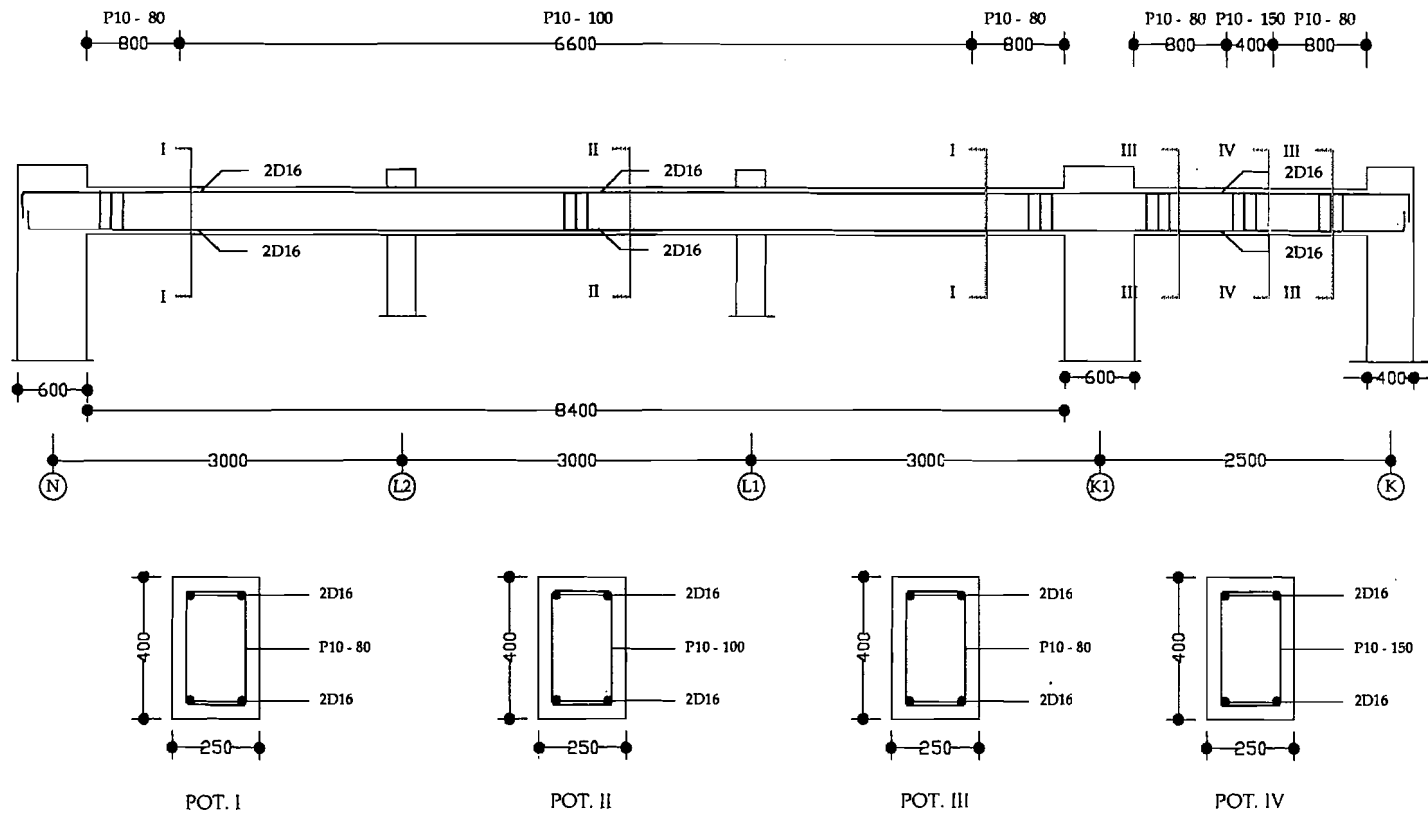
Detail Tulangan Balok BA3 Atap
